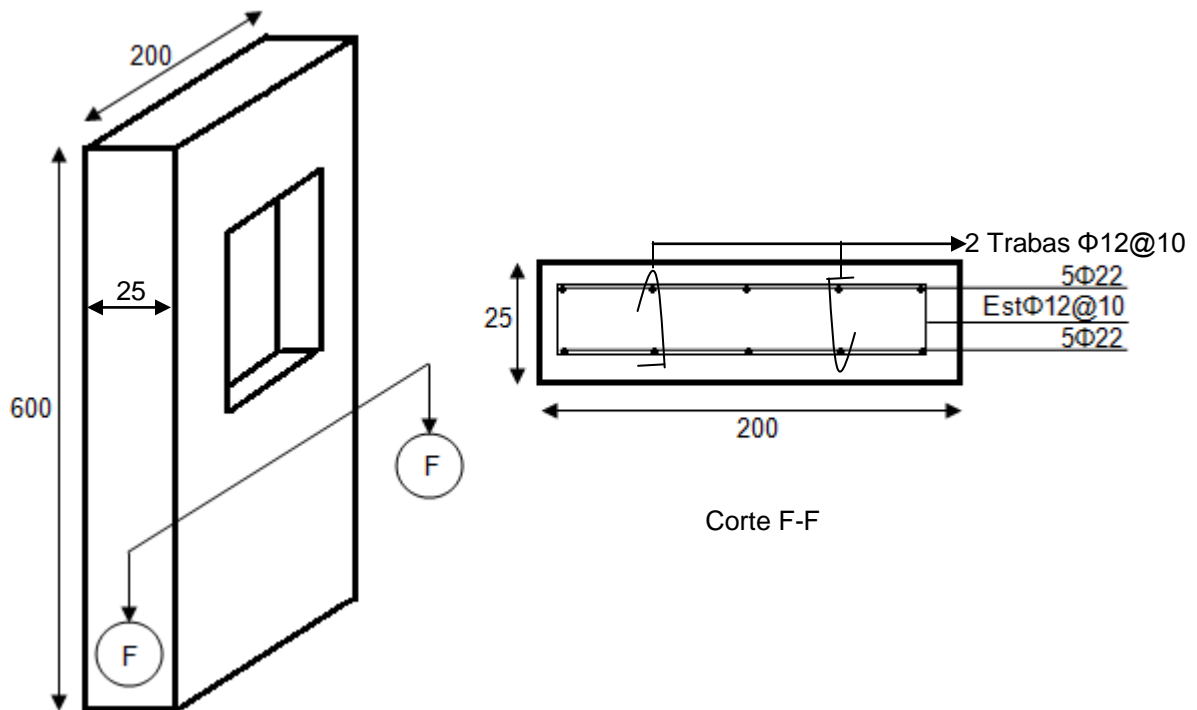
Diseño estructural del muro que se ubica en el lado del valle.
